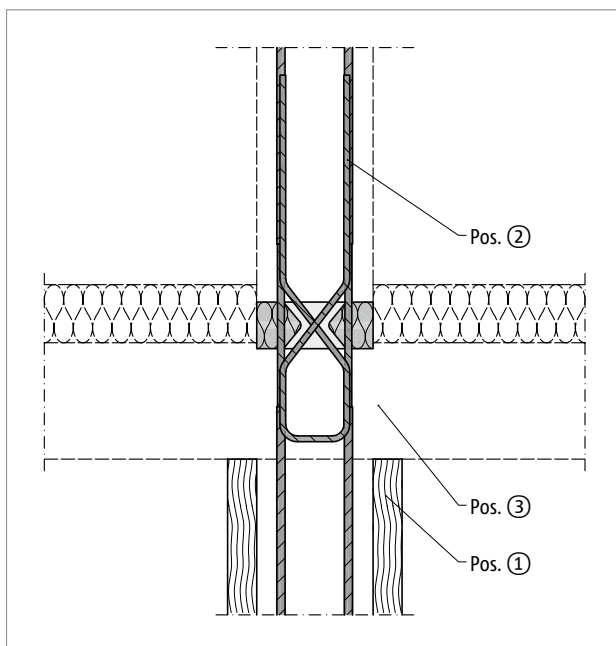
Schöck Sconnex® Typ W-NT-VH-L: Einbau des Typ W mit Leistungsmerkmal T und Formvariante L für die Aufdeckendämmung in die Wand unter der Decke
